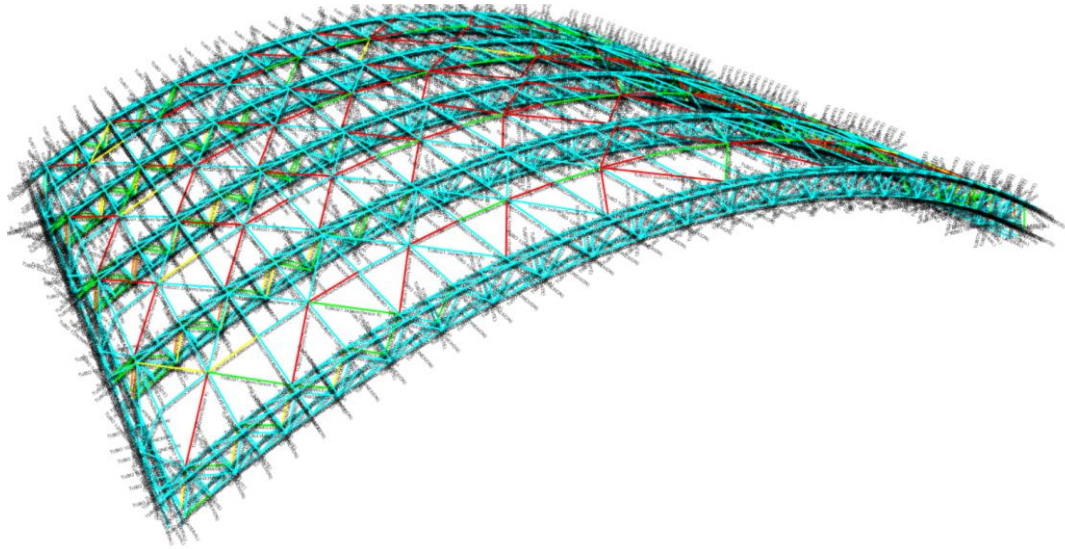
Verificación de secciones de elementos metálicos en nave industrial 2
